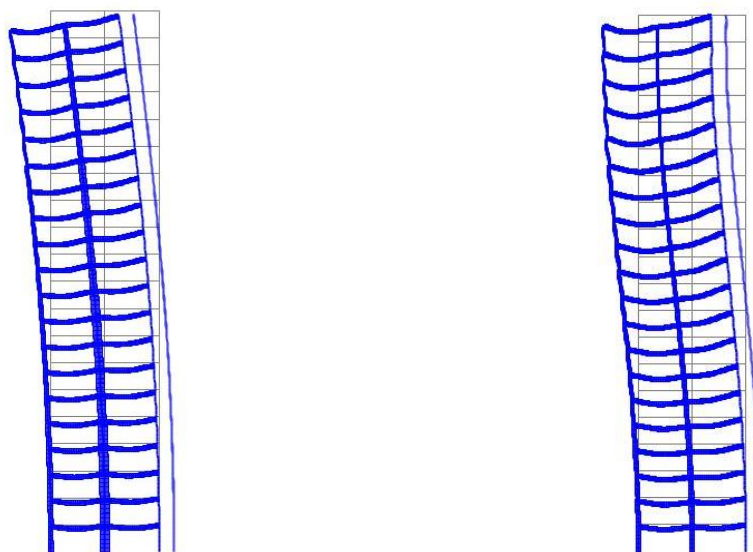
Deformada da estrutura para carregamento global e carregamento faseado
